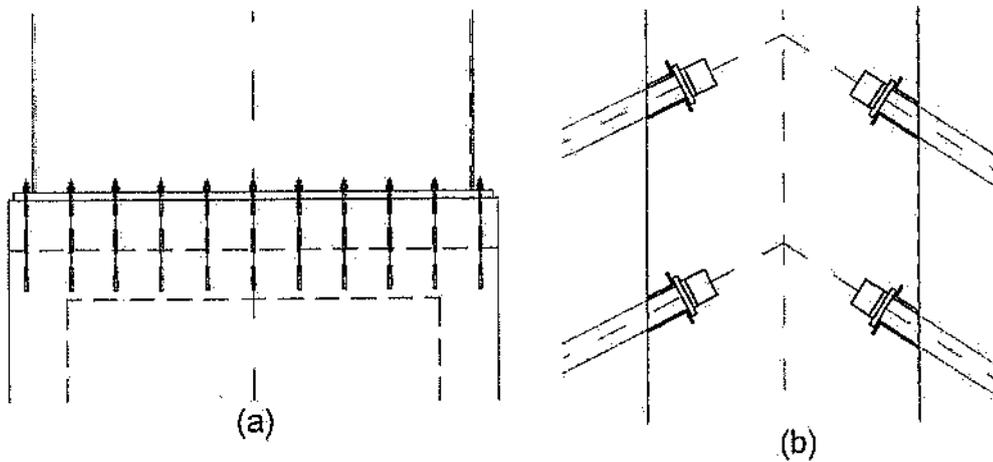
Detalles de la antena: (a) conexión entre la sección en hormigón armado y la sección en acero; (b) conexión de los tirantes
